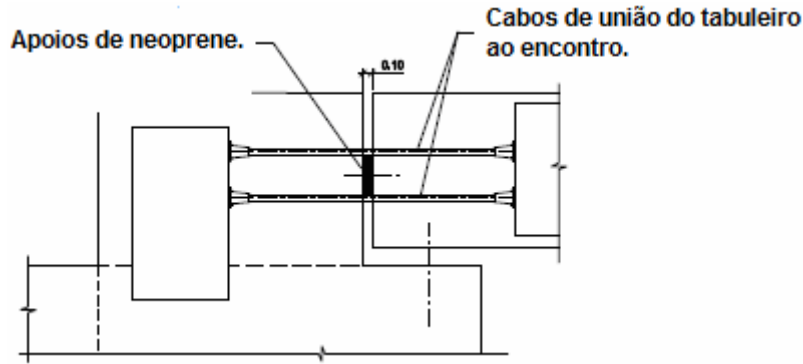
Pormenor da ligação entre o tabuleiro e o encontro.
